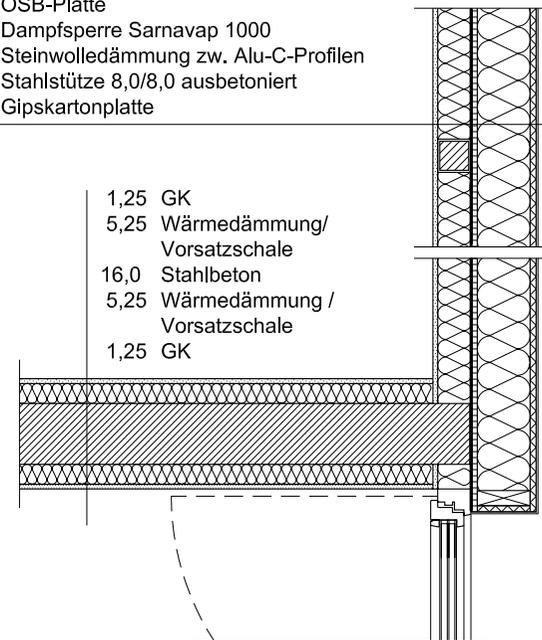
DETAIL ANSCHLUSS AUSSENWAND - TERRASSENTÜR (FENSTER) / WOHNUNGSTRENNWAND
